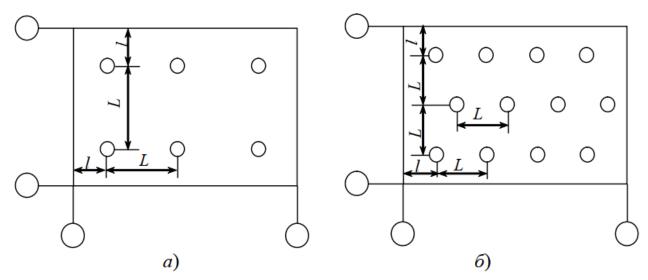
Размещение светильников на плане помещения: а — по углам прямоугольника; б — в шахматном порядке
